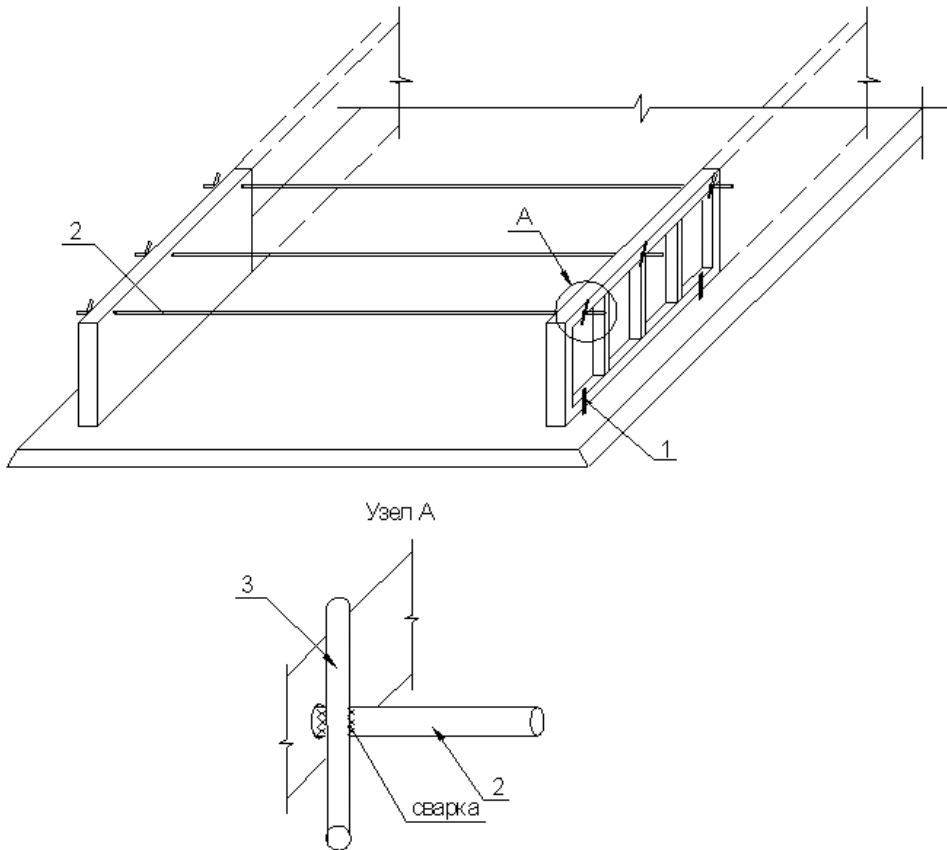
Раскрепление щитов опалубки арматурными стержнями: 1 – анкер (арматура ф12, L=250-300мм); 2 – Тяж (арматура ф12), 3 – арматурный стержень (L=100-150мм), привариваемый к тяжу вместо гайки.
